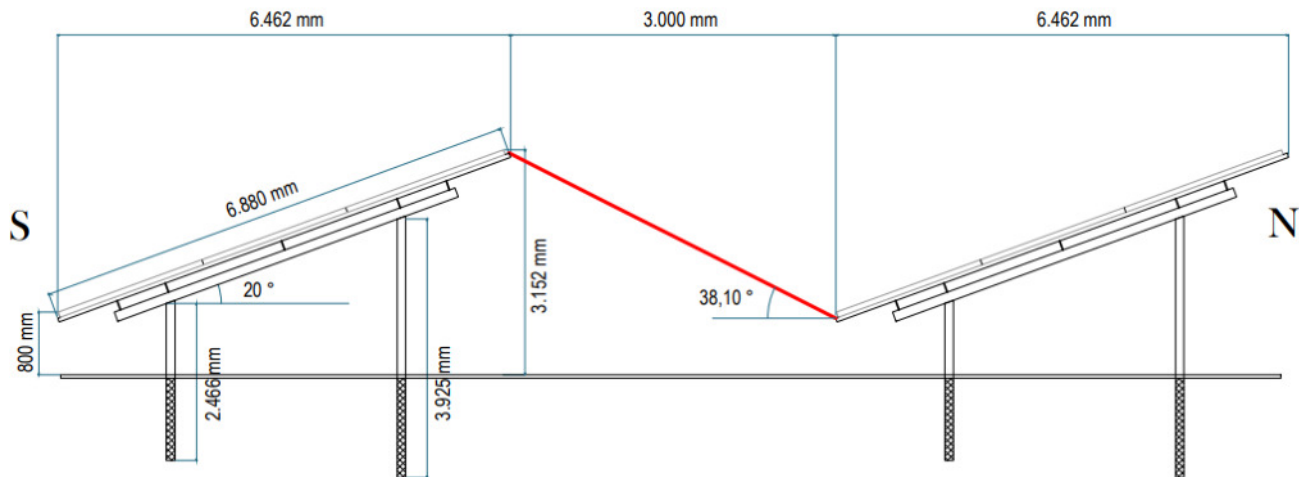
Skizze der Modulkonstruktion (Quelle: Planungsunterlagen)
